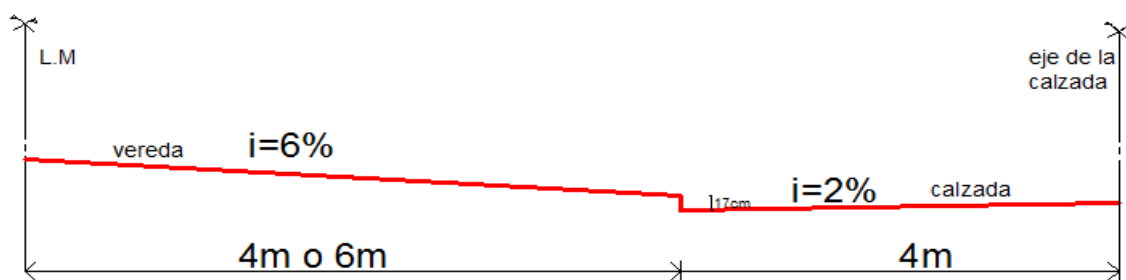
Cordón cuneta, calles pavimentadas (fuente: Elaboración propia).
